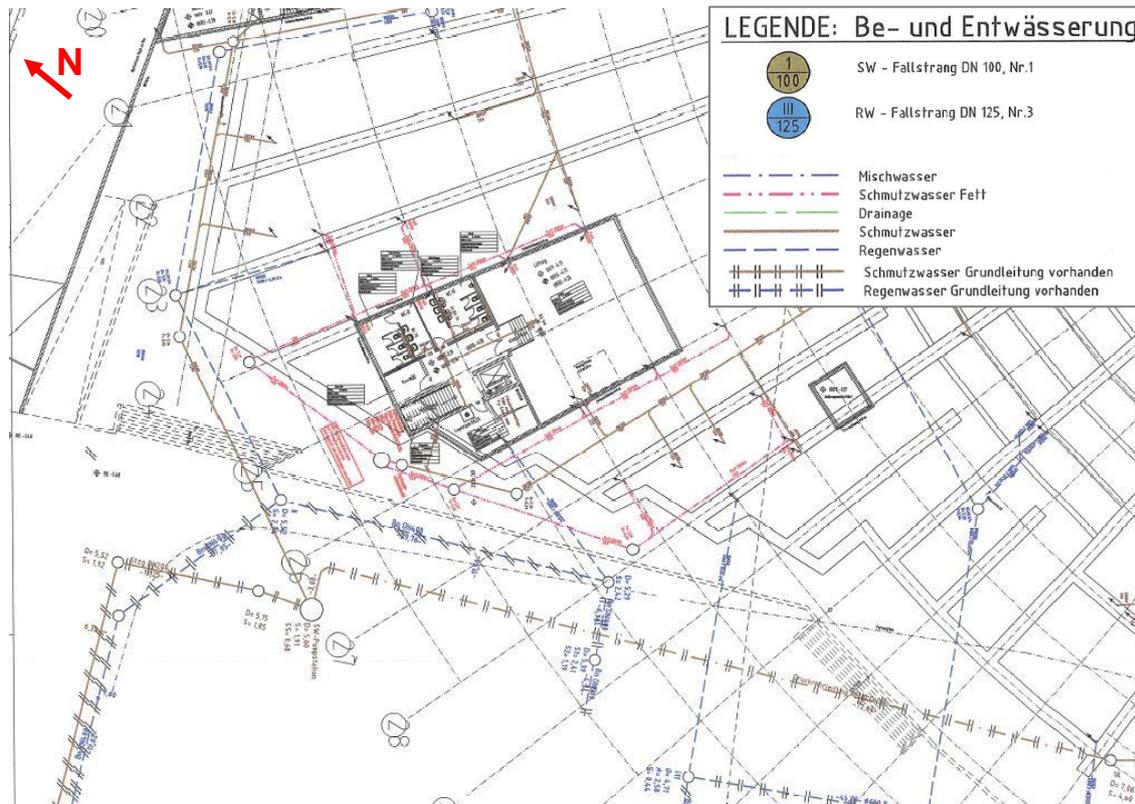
Bestehendes Leitungssystem Kellergeschoss – Ausschnitt aus dem Plan B-HG-01-00/3 (Stand: 26.06.2001)
